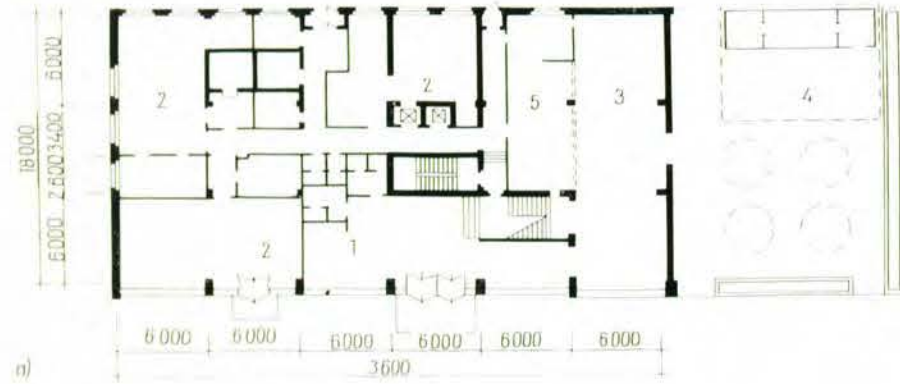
Typenprojekt einer Gaststätte für 270 Plätze mit Endküche
